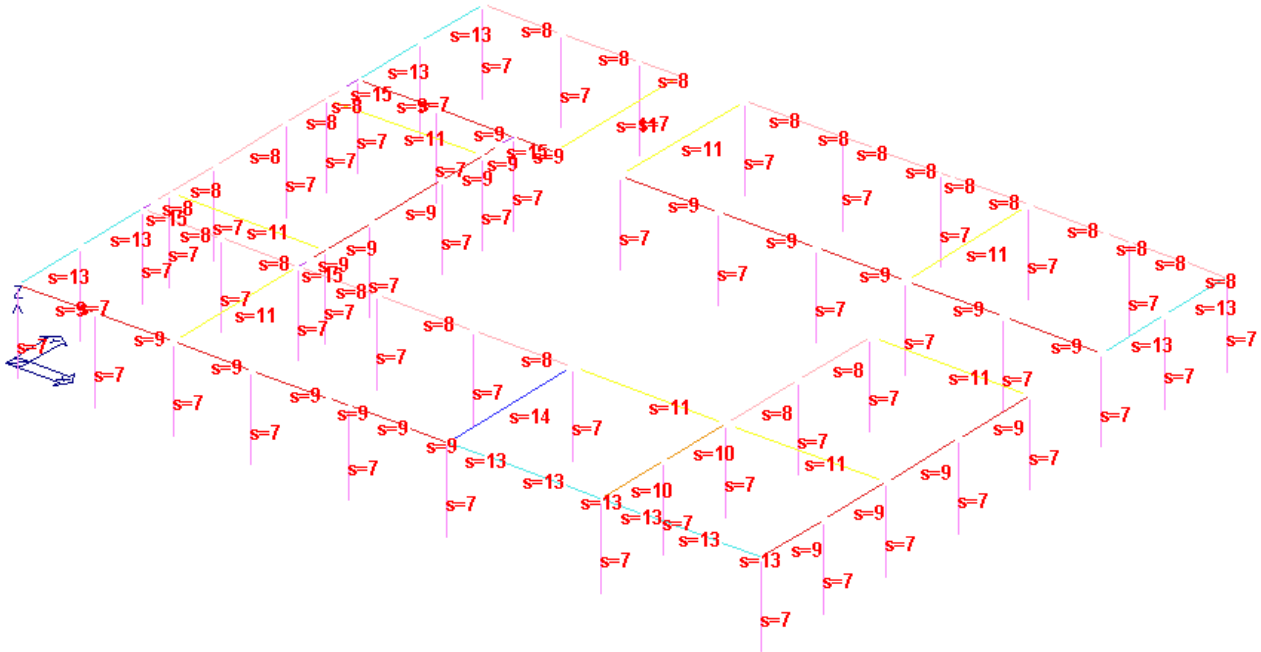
1 – Codice “Id” elementi strutturali in c.a. in elevazione
